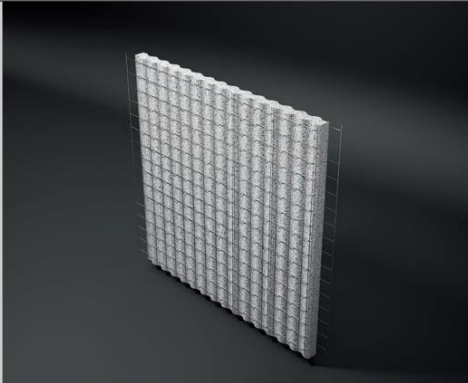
3D du panneau CONCREWALLCONSTRUCTION SYSTEM. .source Google photo site consulté mai 2019
